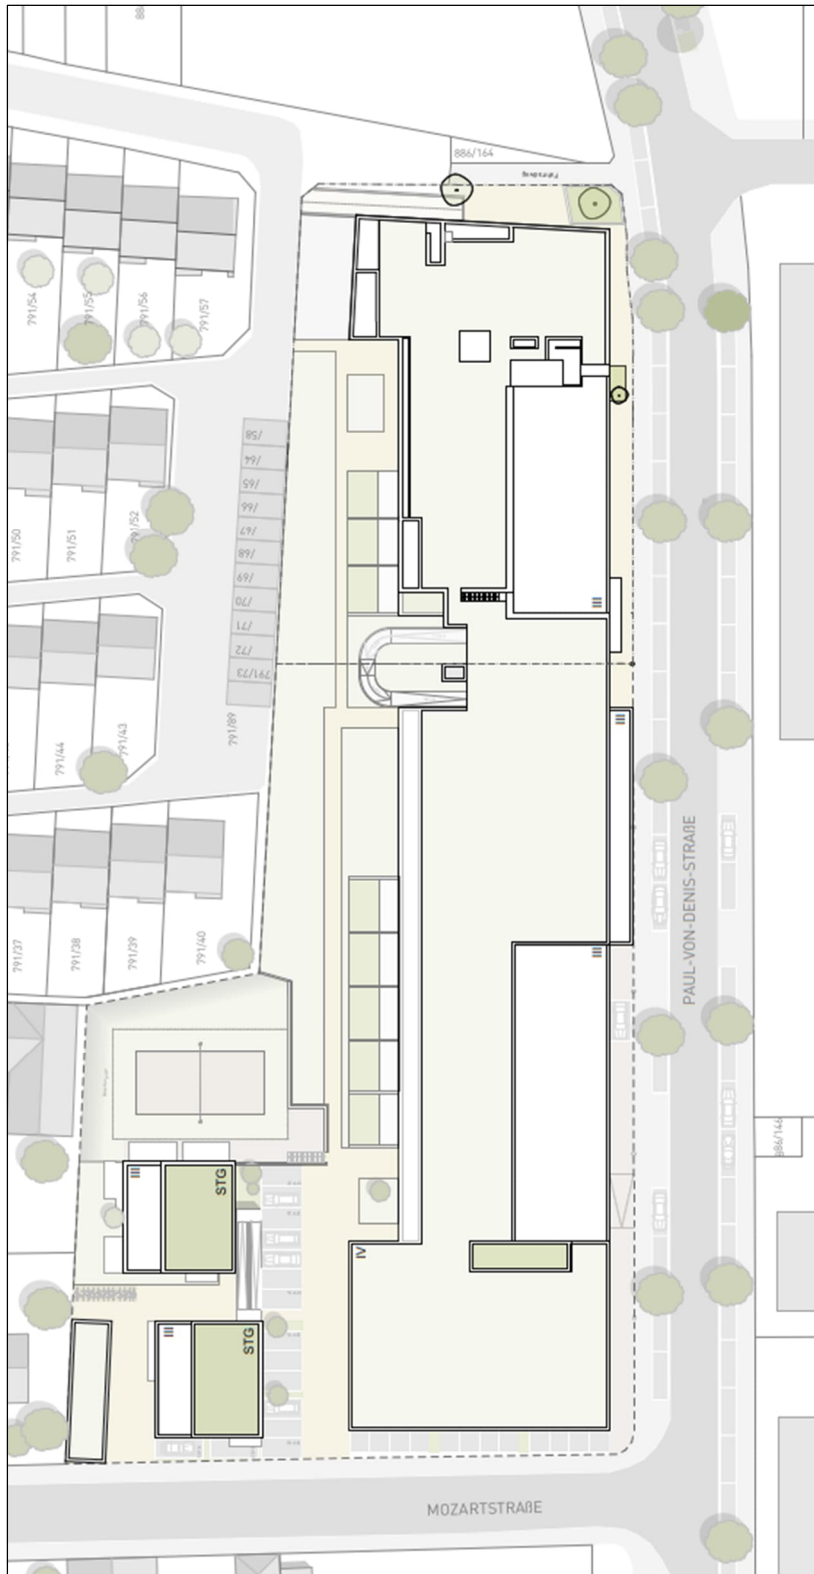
Lageplan FitterCampus, Hausgemacht Architekten GbR Stand 11.04.2023
